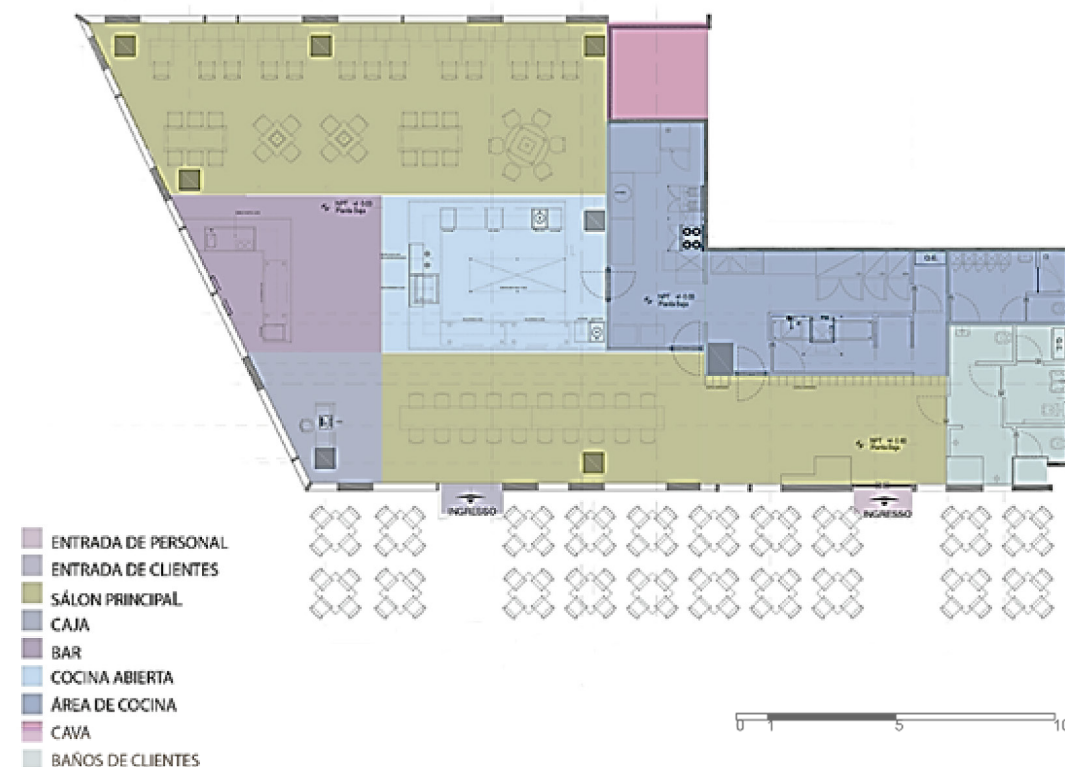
Zonificación Planta Baja. Elaborado por Lizbeth Ochoa. Recuperado de ArchDaily, 2016.
